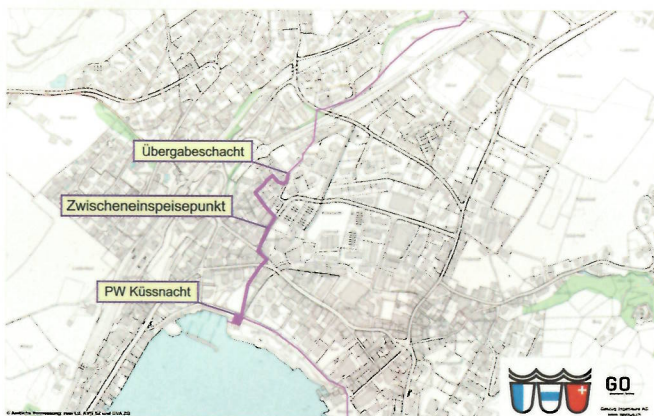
Übersichtsplan der Abwasserdruckleitung des GVRZ in Küsnacht
